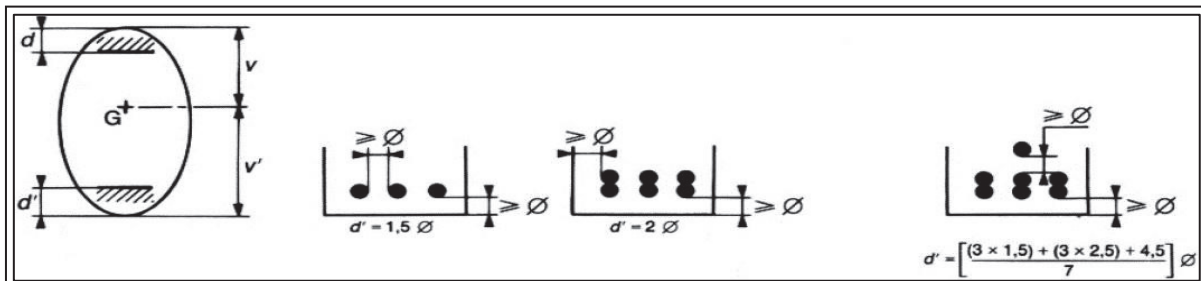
DISPOSITIONS CONSTRUCTIVES DES CABLES DE PRECONTRAINTE.
